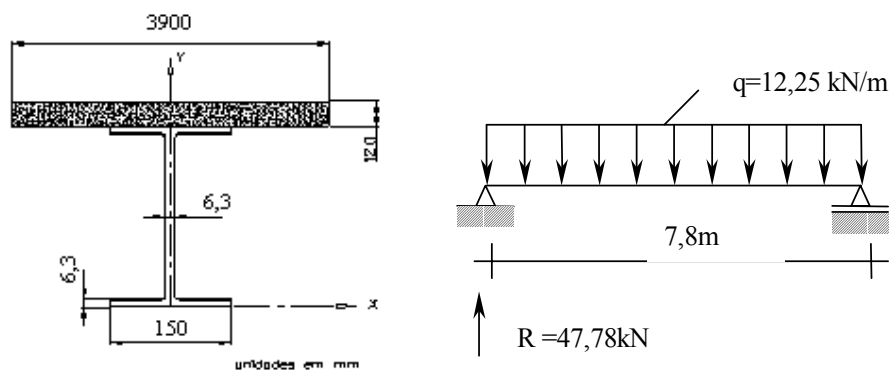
Seção transversal e esquema estrutural da viga V11
